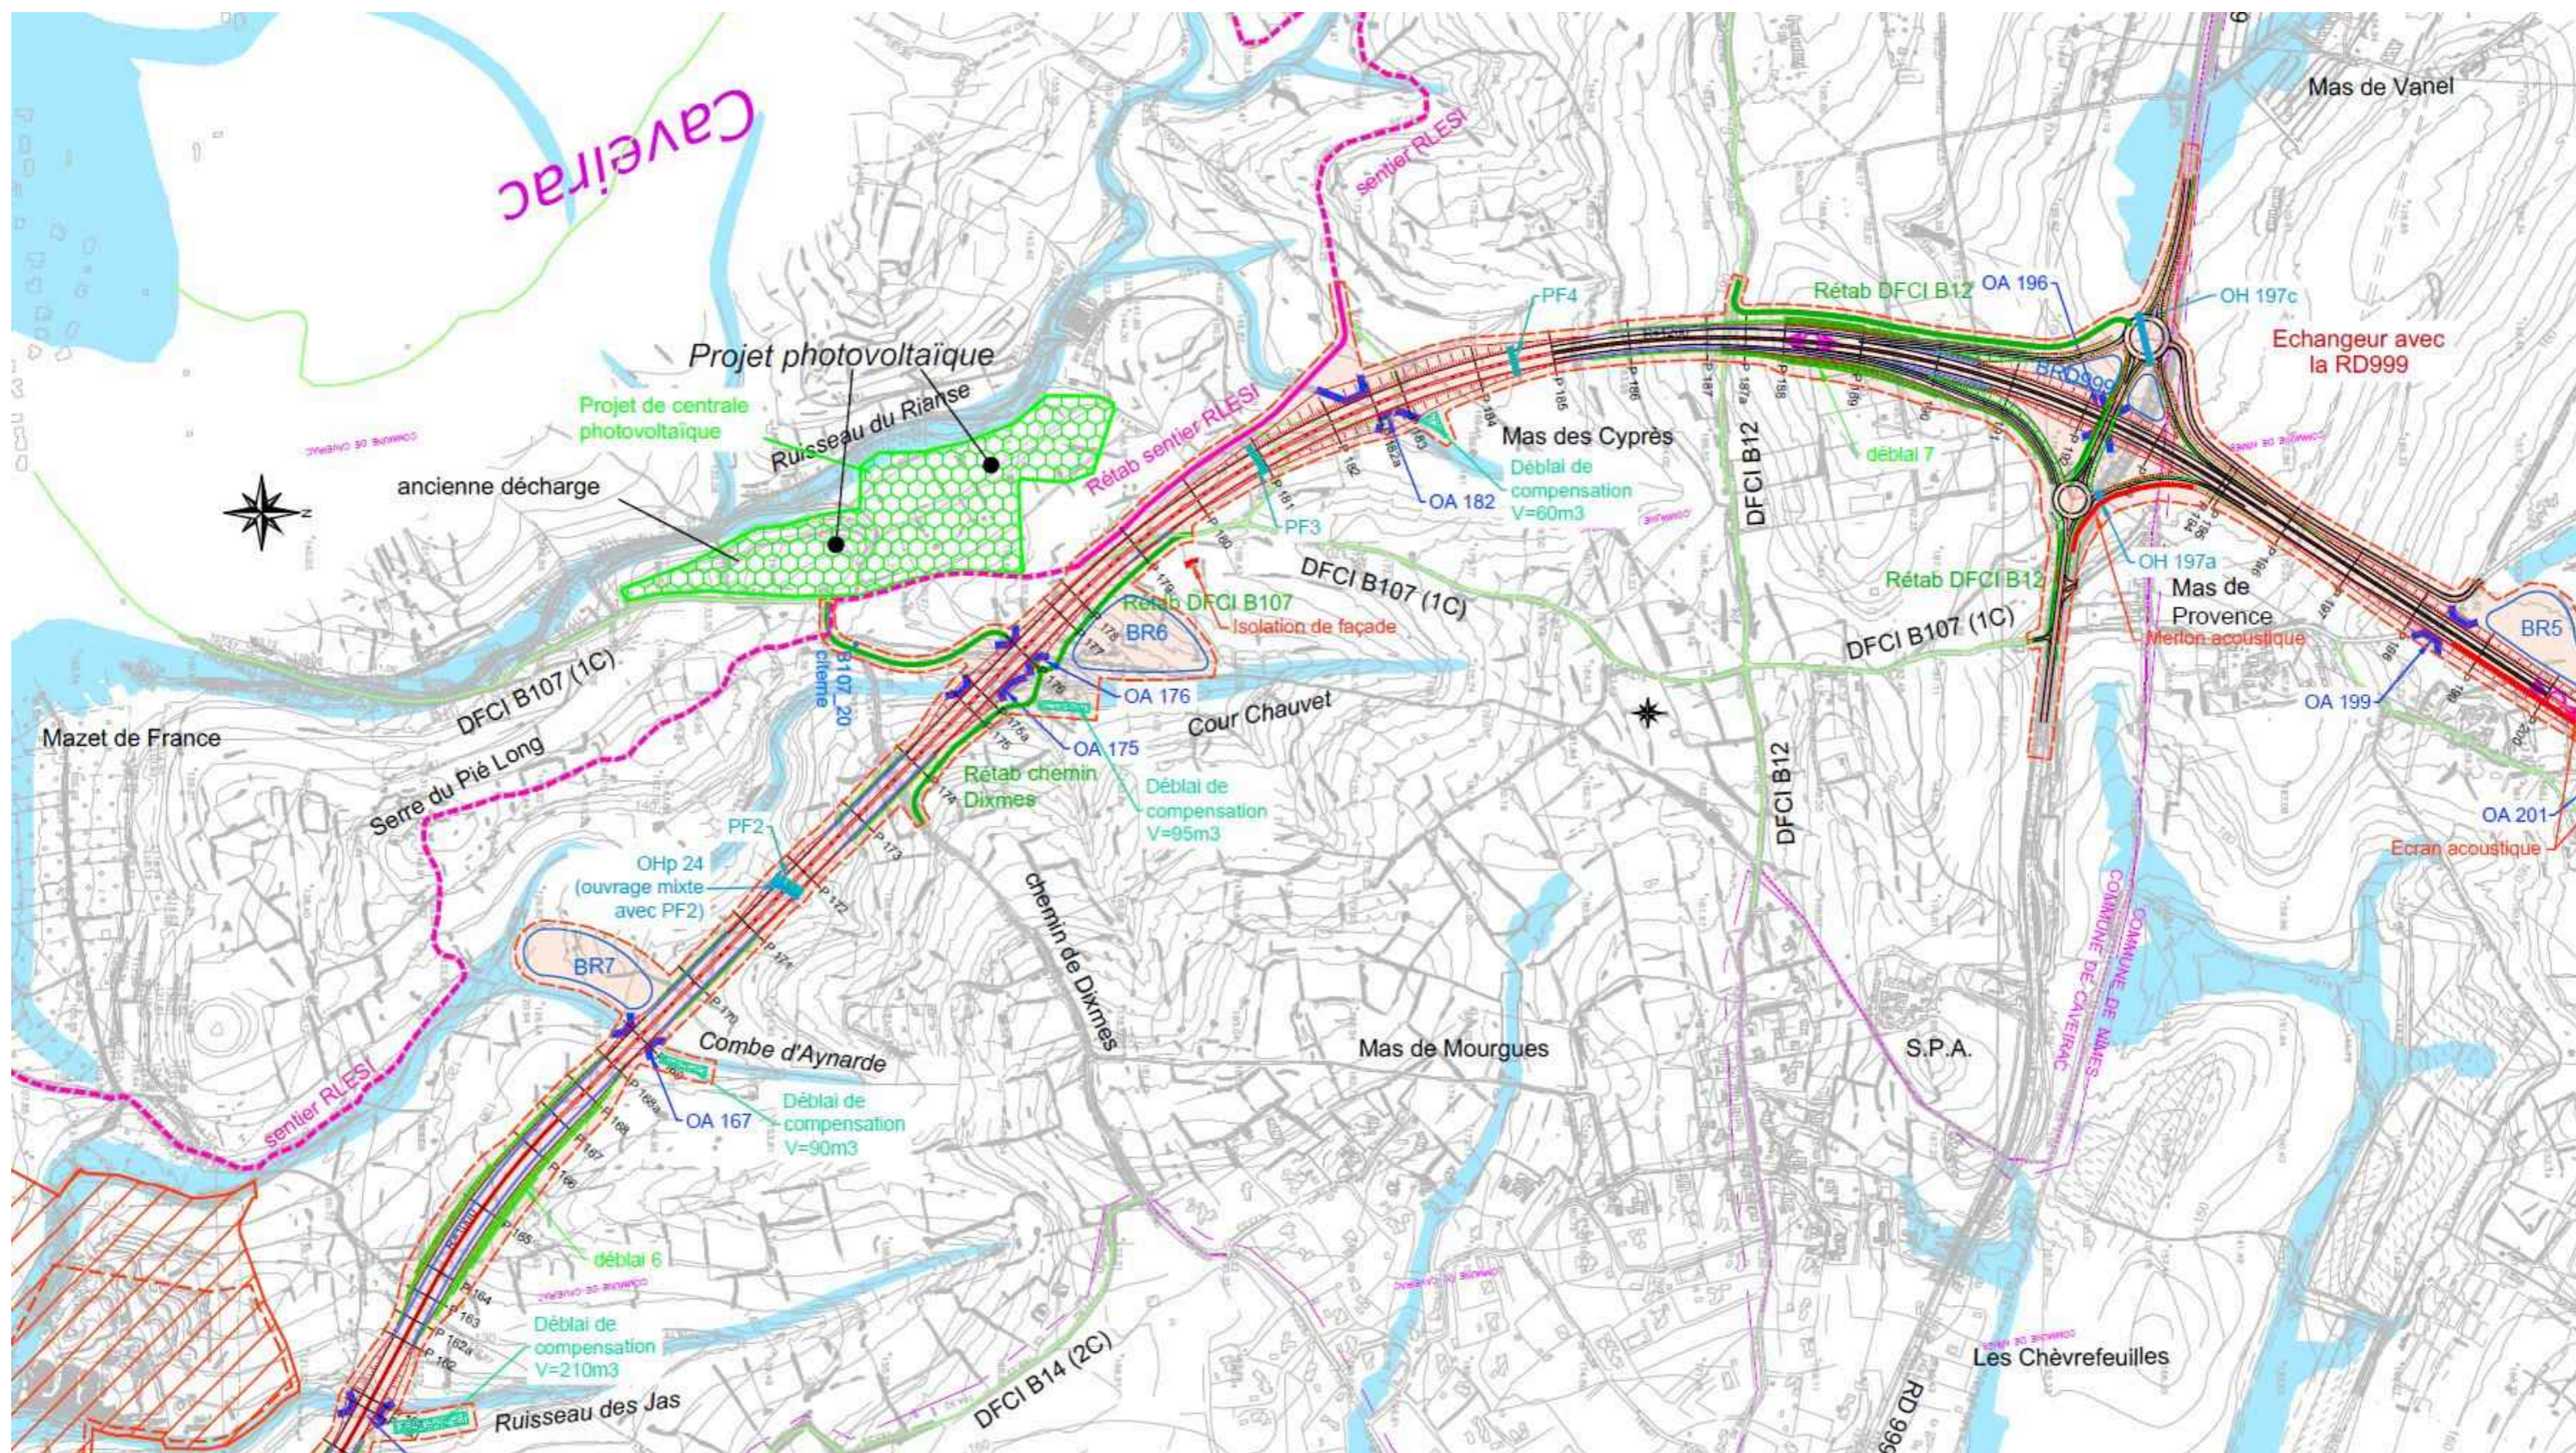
plan de masse du projet 2/4 (Source : Présents, juin 2021)
